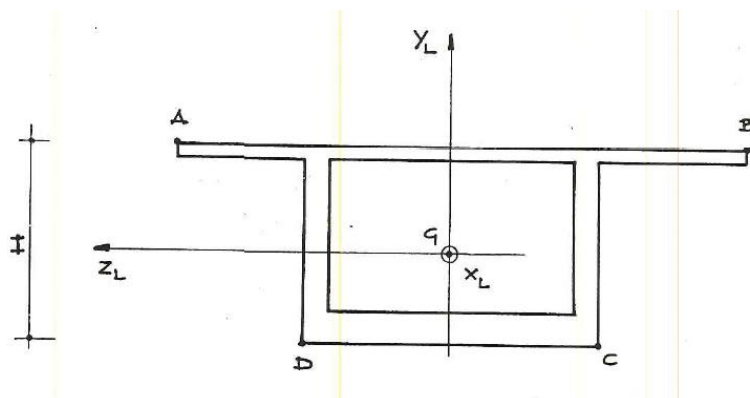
Convenzione sistema di riferimento per proprietà meccaniche e stato tensionale dell'impalcato[1]
